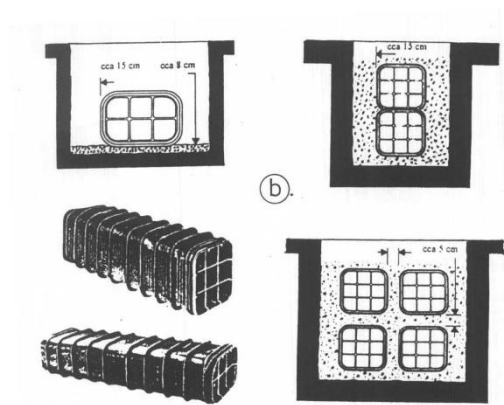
Příklad uspořádání VTTV v technických chodbách
